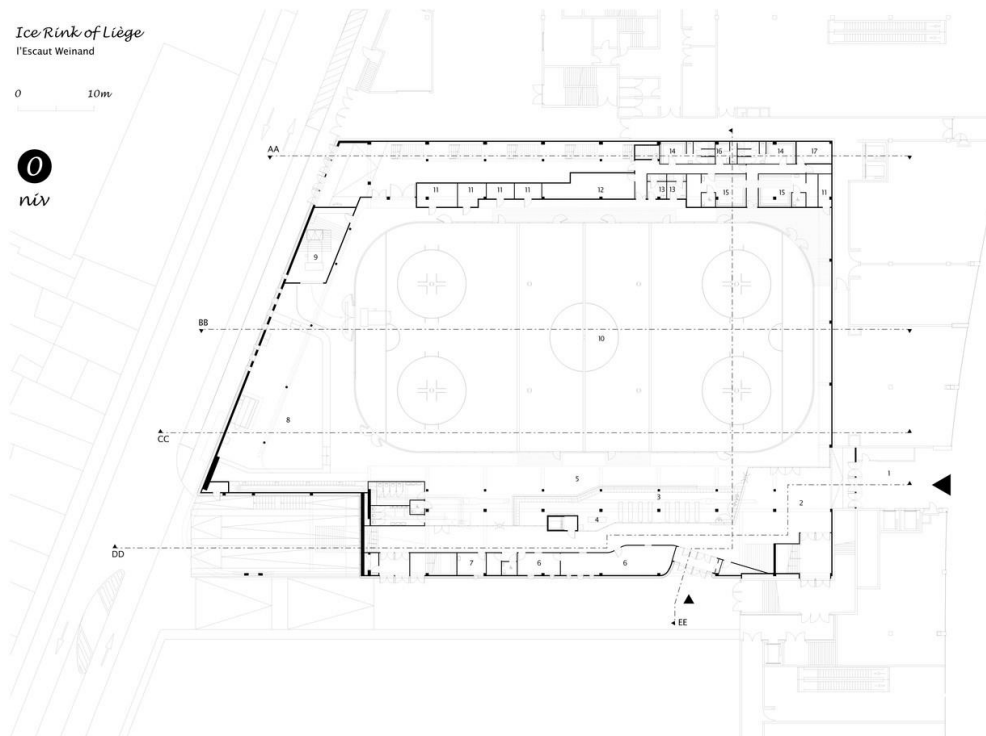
План нульового поверху, арх. L'Escaut Architectures + BE
